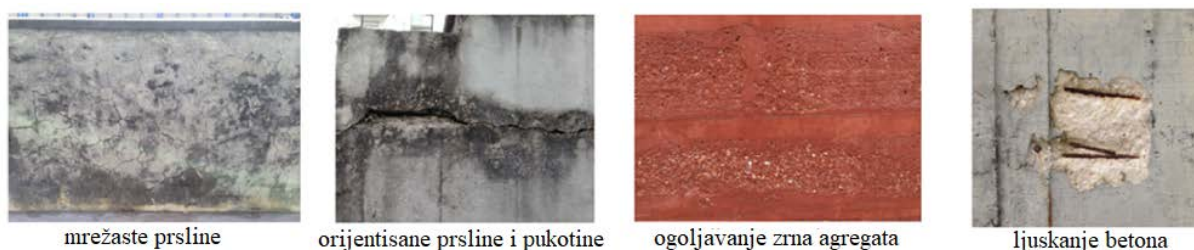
Estetska oštećenja betonskih fasada (Serralheiro et al., 2017)
